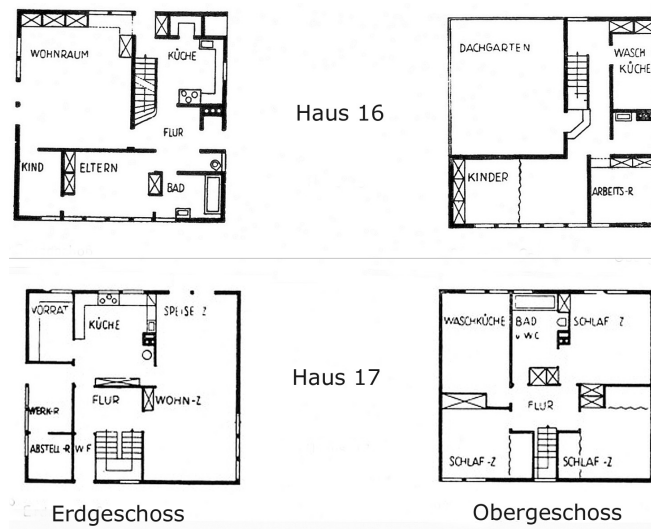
W. Gropius, *Haus 16 u. 17*, Grundrisse, Stuttgart Weissenhof 1927
